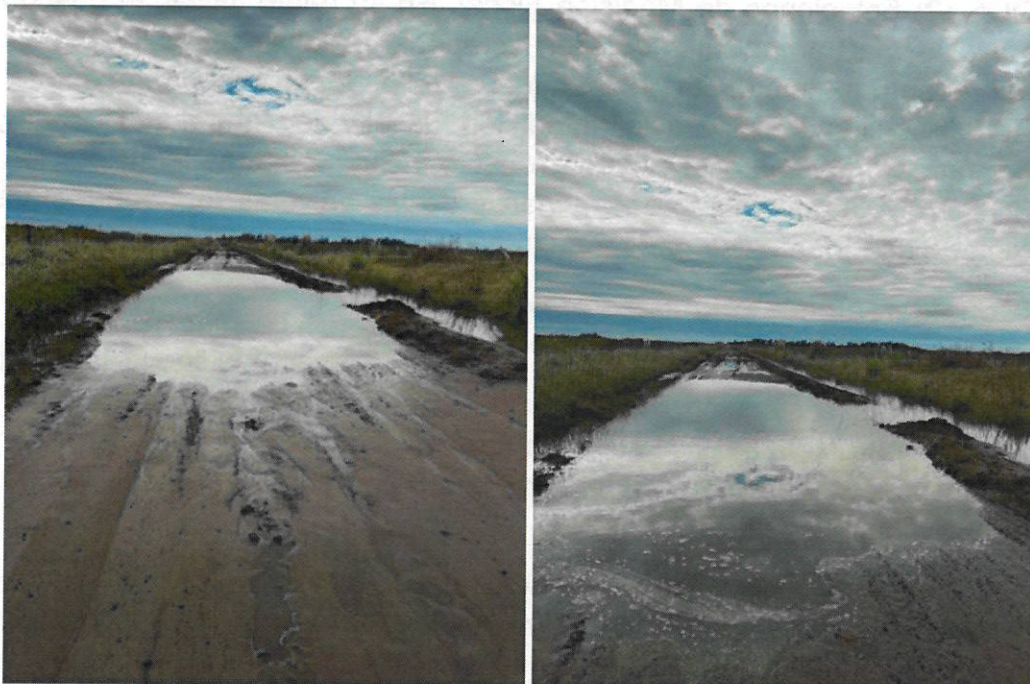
Estado de los caminos de acceso a la zona de obras
